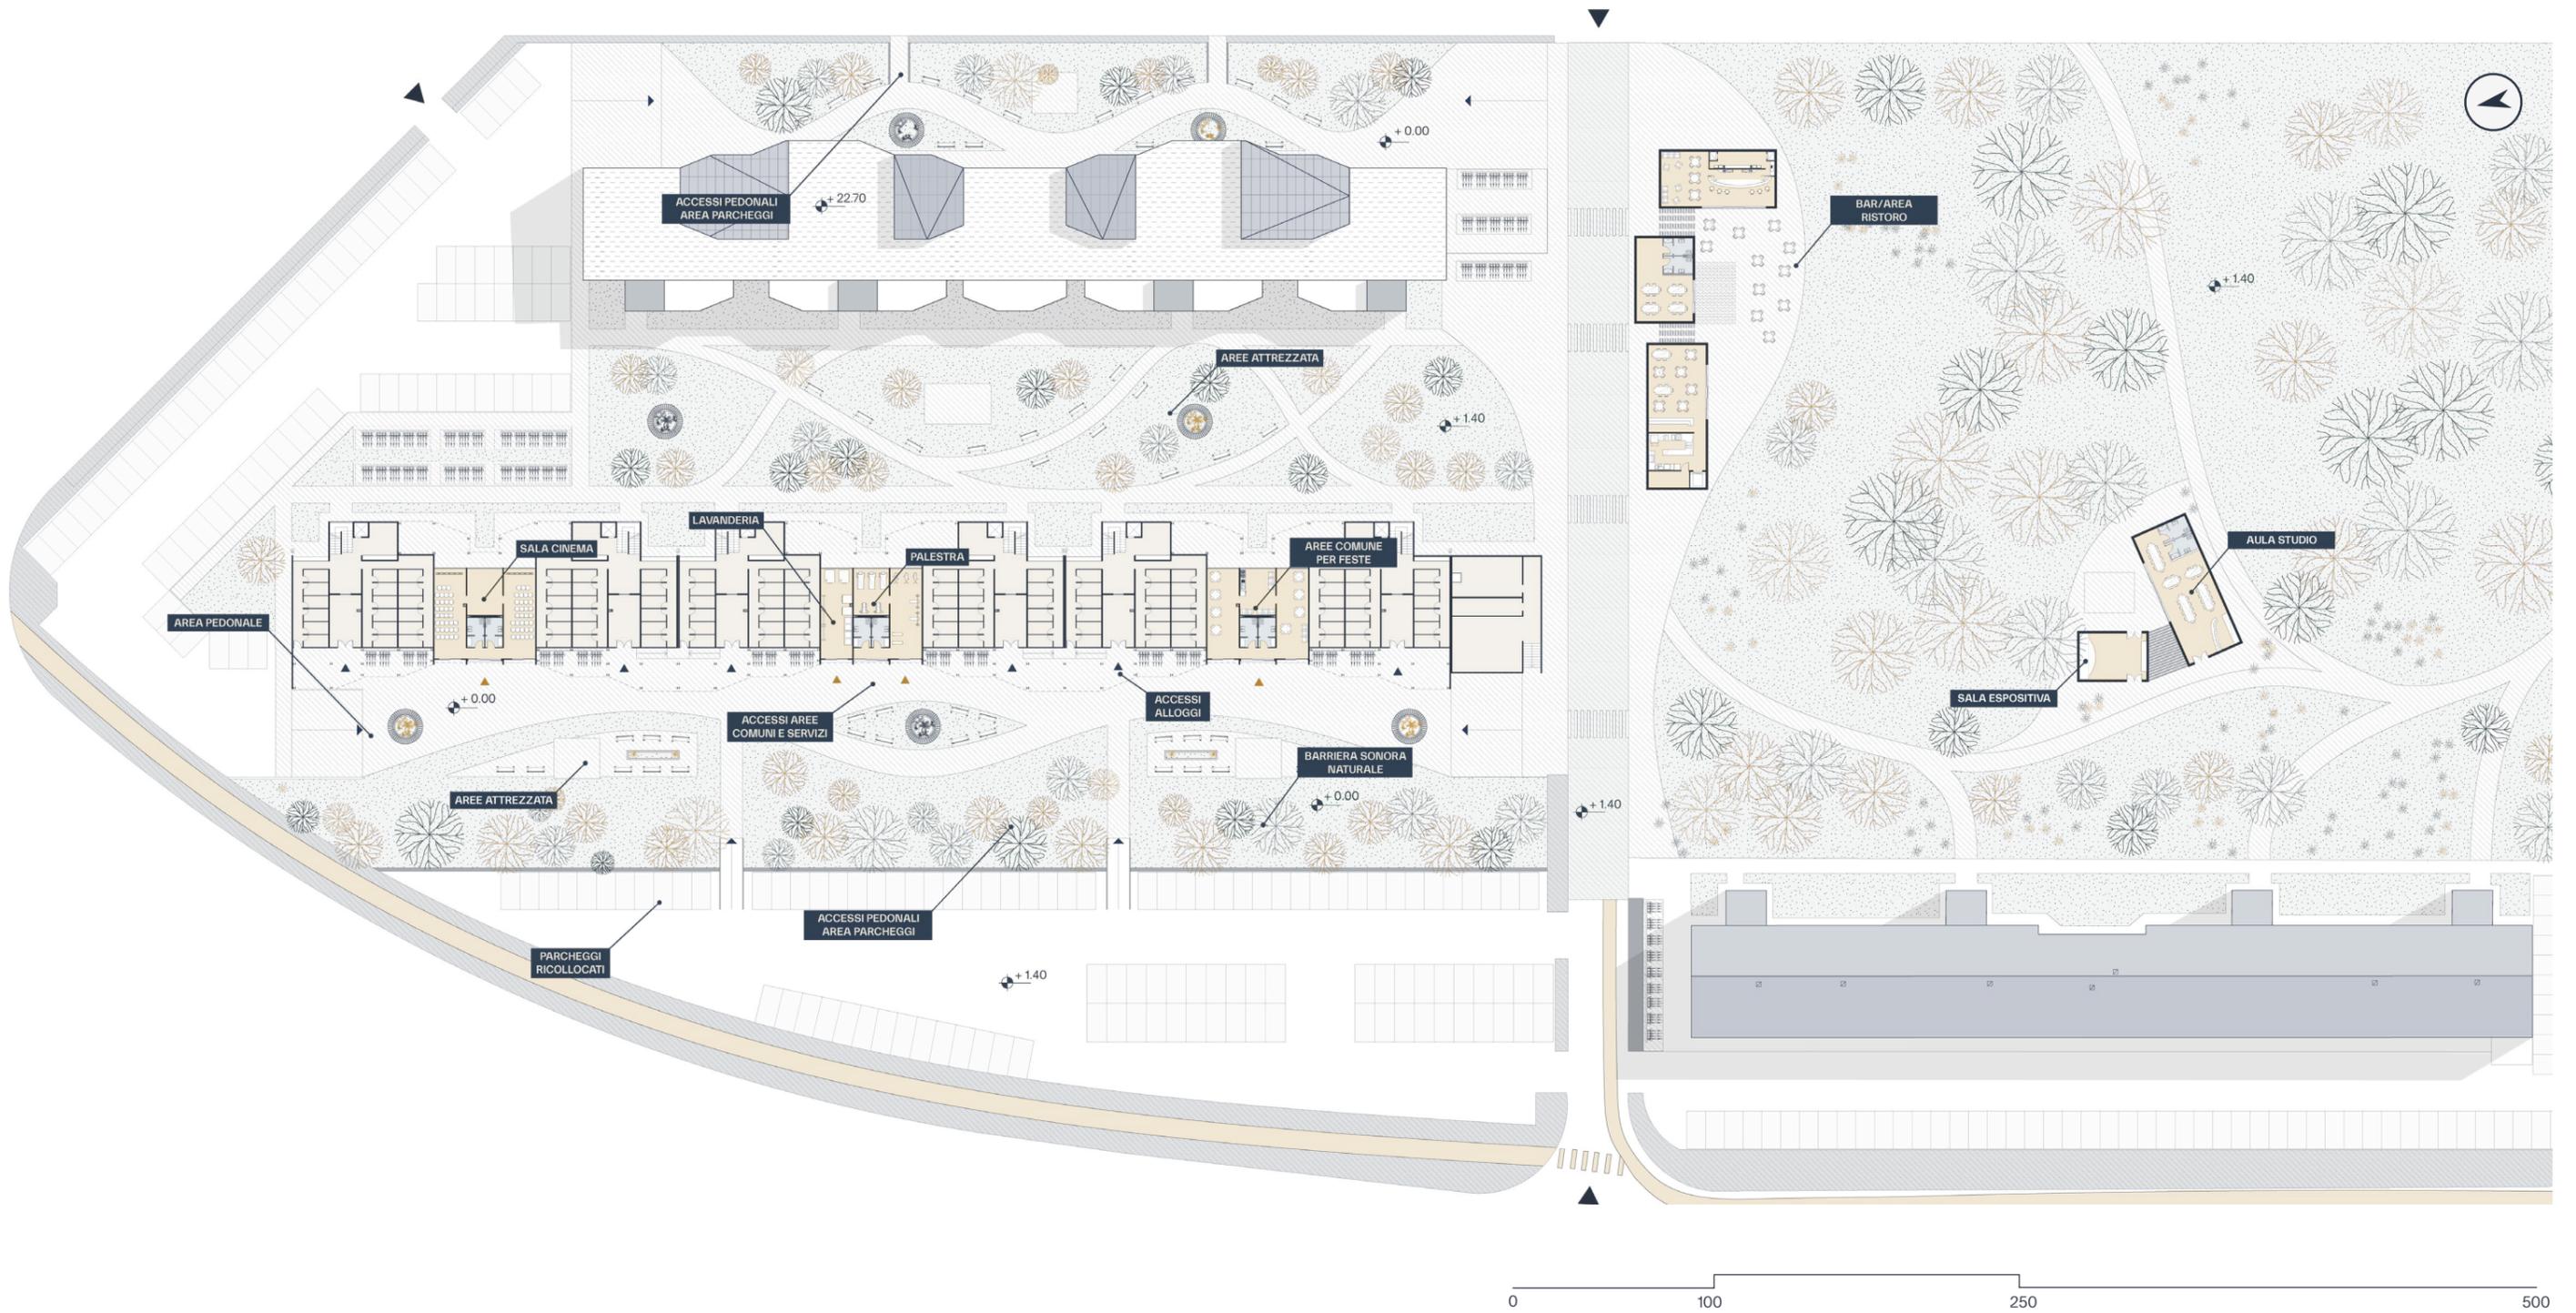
Planimetria piano terra e servizi - Progetto
